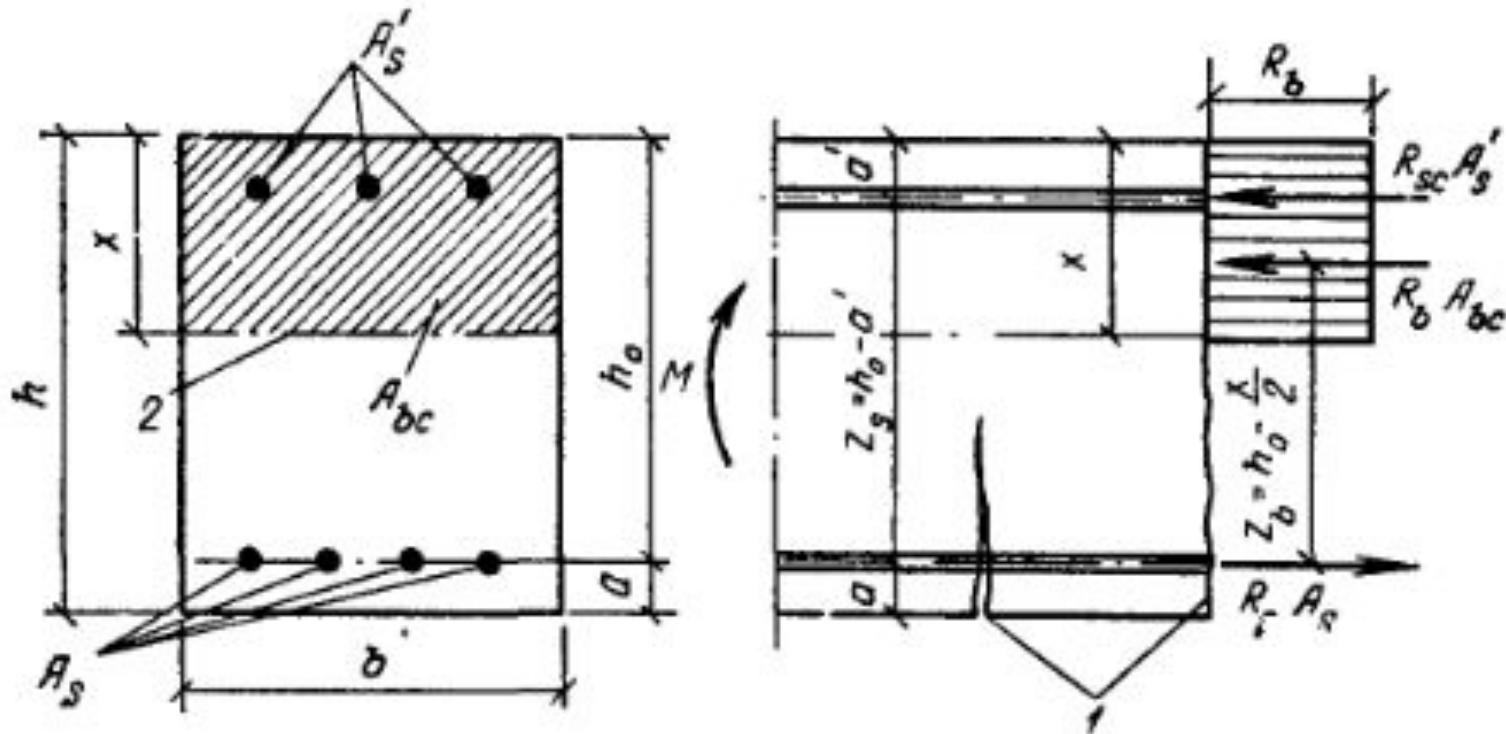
Расчётная схема изгибаемого элемента с двойной арматурой
